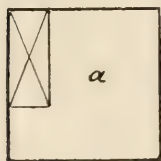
Plan d'un logement d'ouvrier célibataire.
